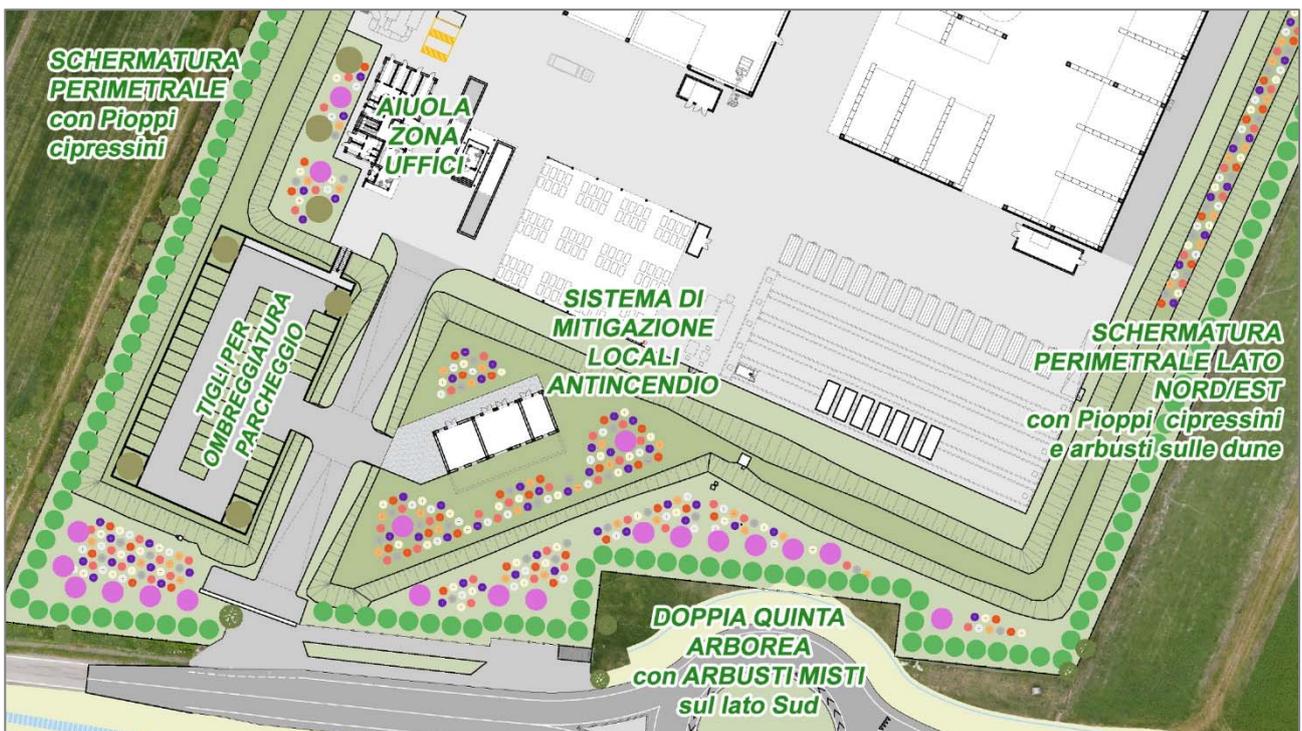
Estratto planimetrico con indicazione di massima delle opere a verde previste
